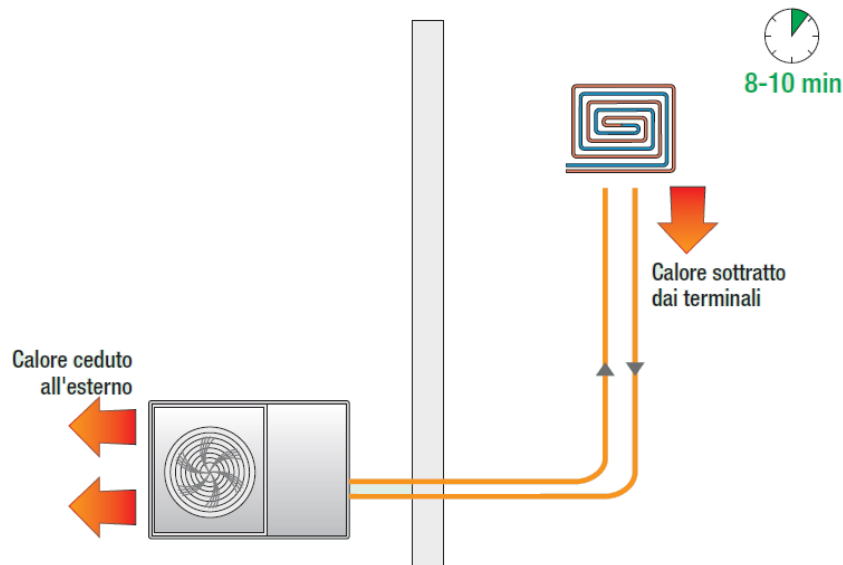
Impianto ad elevata inerzia (Caleffi, 2021)
